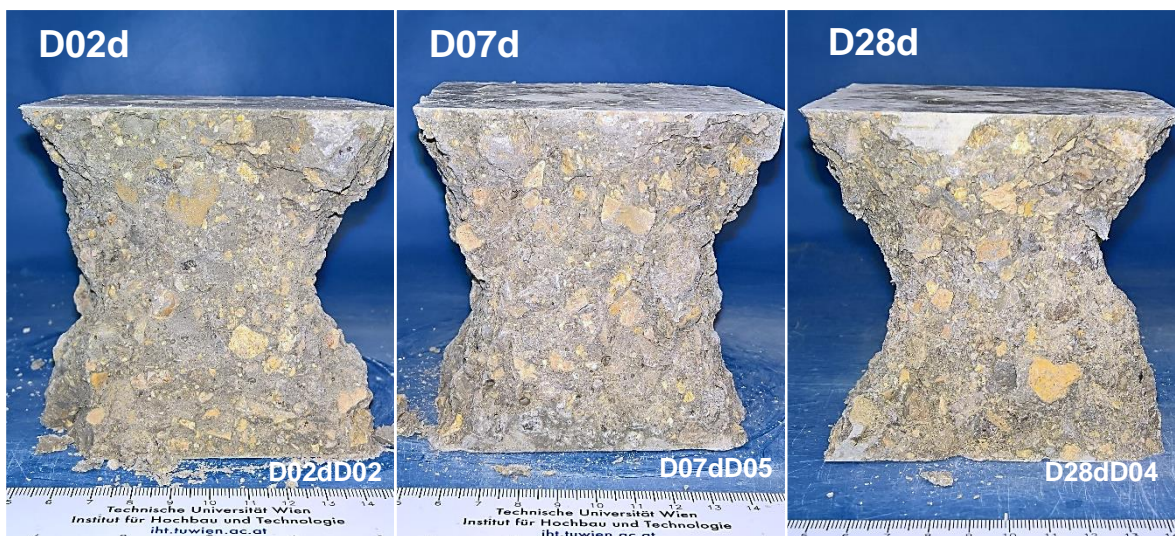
Bruchbilder Einachsialer Druckversuch – Beton mit Dolomit und einem Probenalter von 2, 7 und 28 Tagen [Autor]
